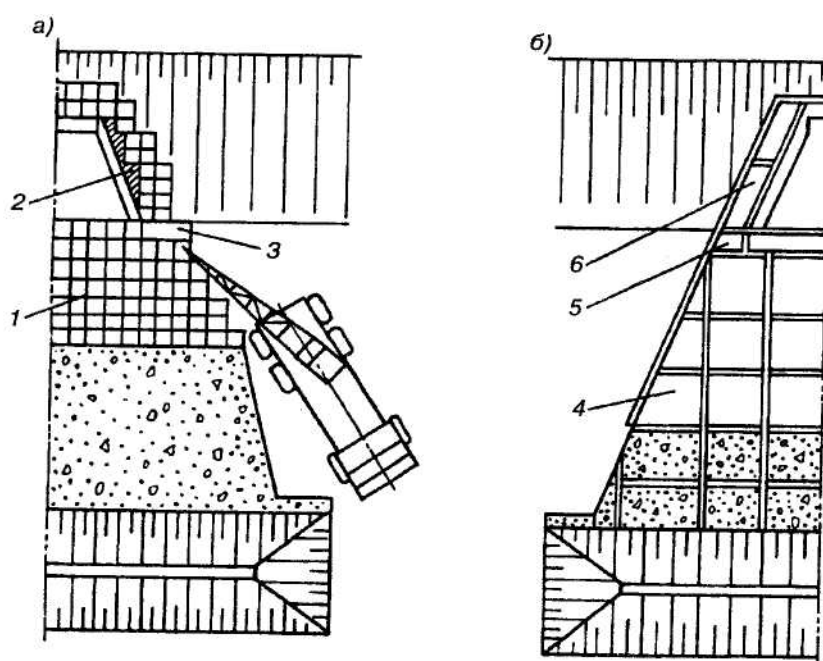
Схема укрепления откосов насыпи у оголовков и лотков сборными (а) и монолитным (б) бетонными плитами:
